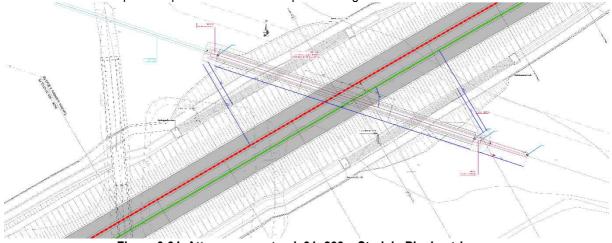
Attraversamento pk 31+293 – Stralcio Planimetrico
